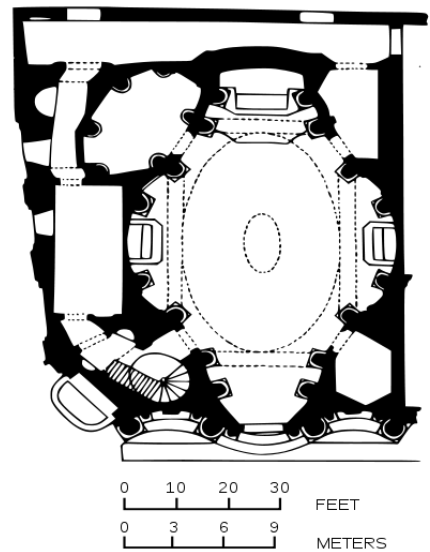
Igreja de San Carlino alle Quattro Fontane, Planta
